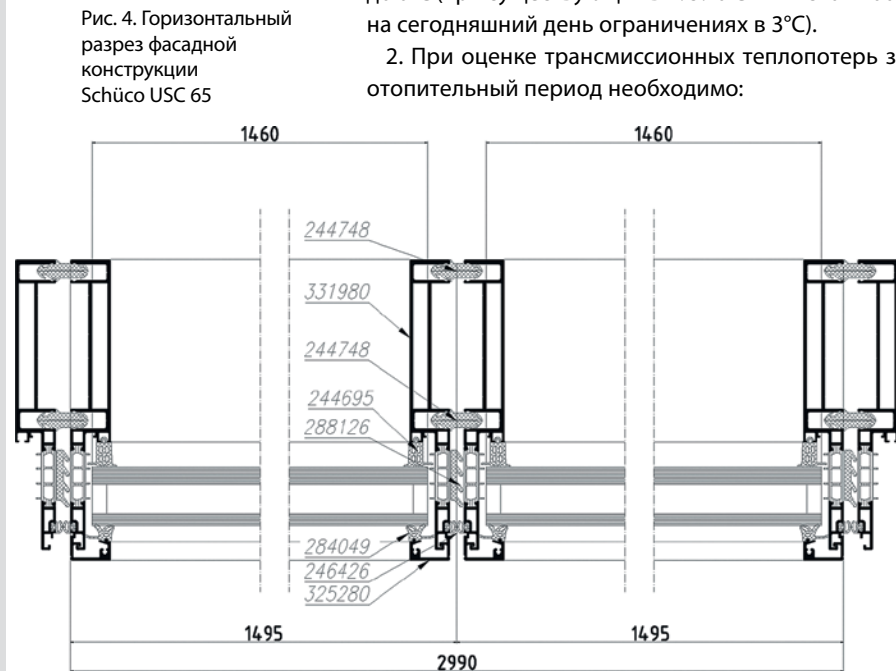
Горизонтальный разрез фасадной конструкции Schüco USC 65
